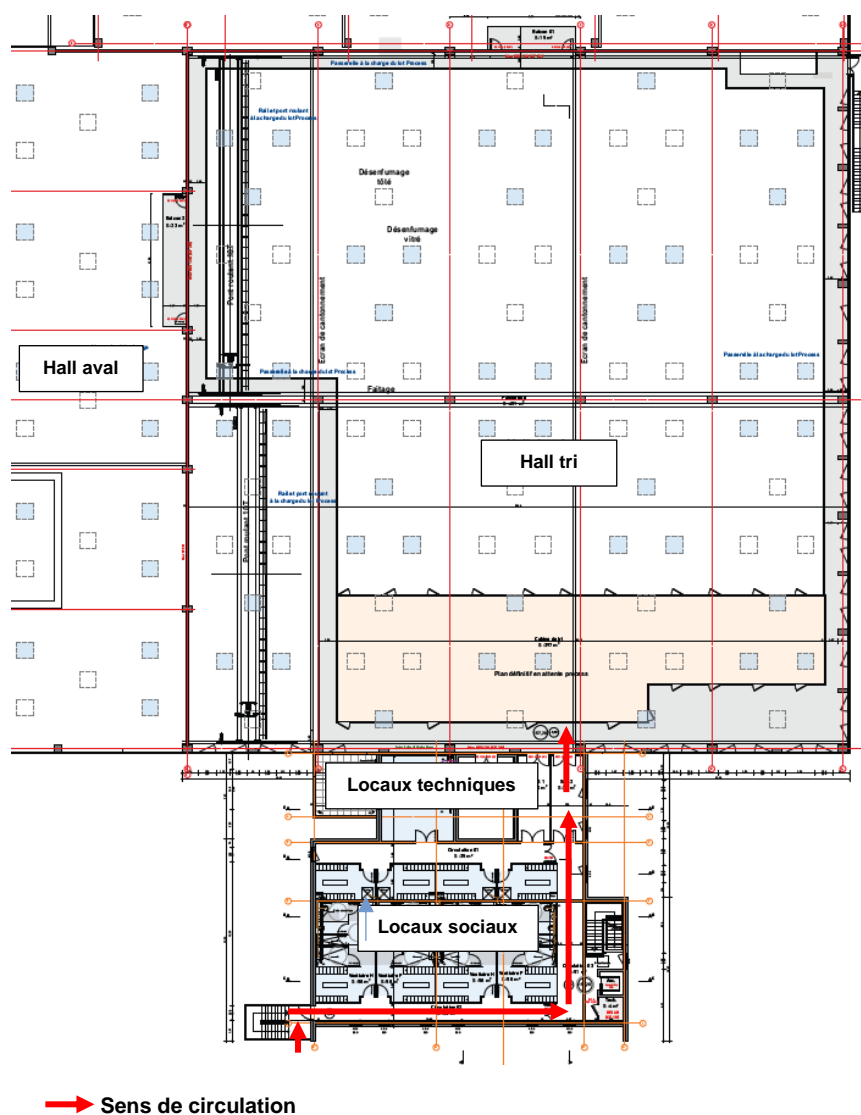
Plan de principe accès des locaux sociaux et techniques au hall de tri (source : groupement Trinovia)
